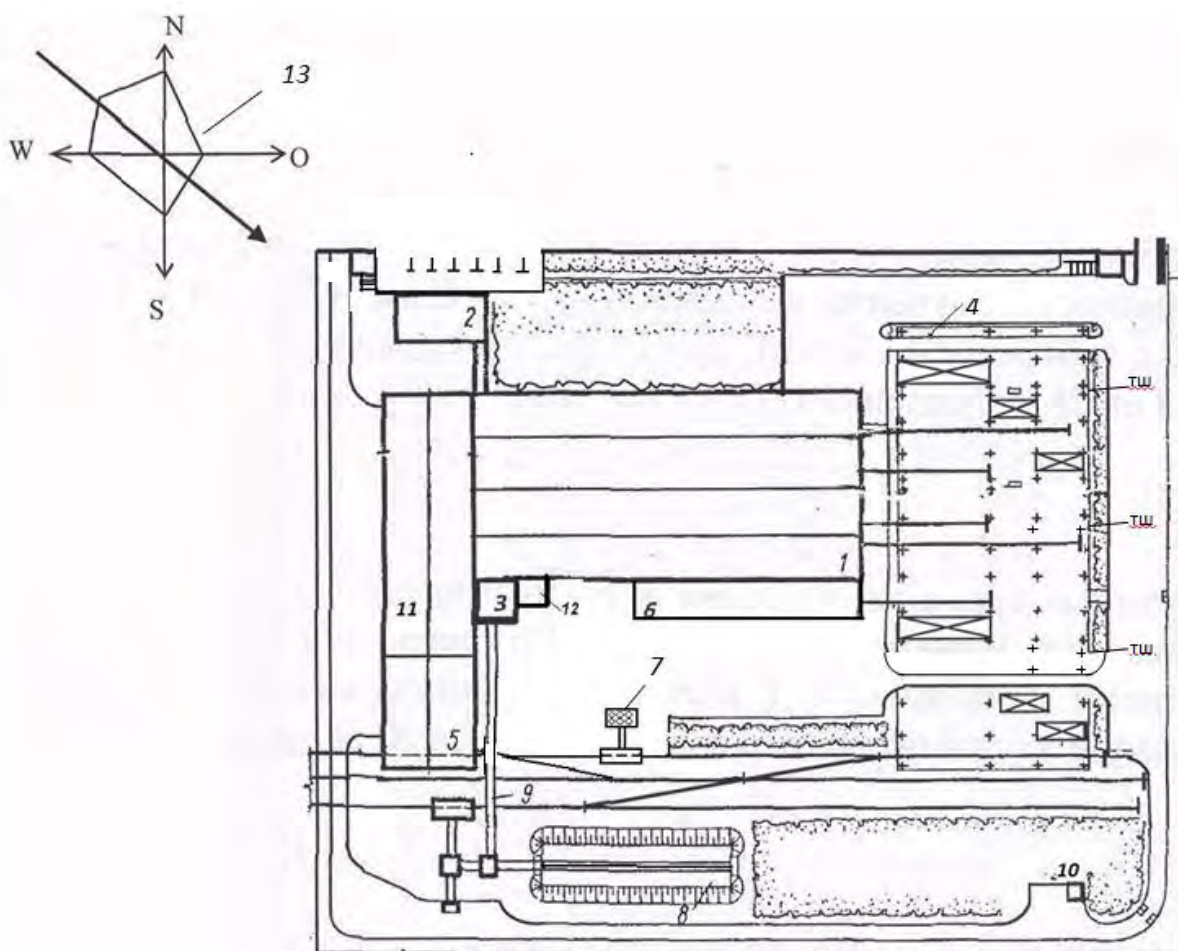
Принципиальное компоновочное решение генерального плана завода железобетонных изделий общестроительного назначения:
